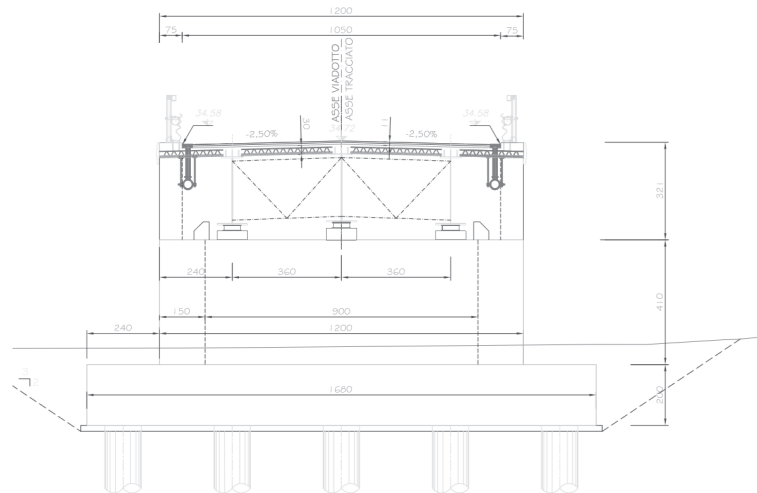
Sezione trasversale dell'impalcato – Sezione in asse pila P1
